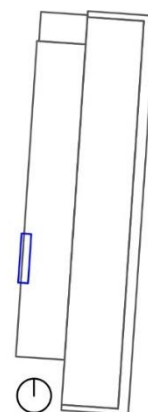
Individuazione del macroelemento in prospetto e pianta
